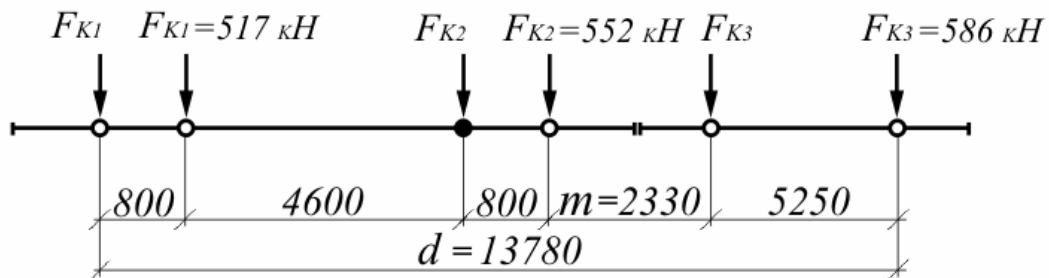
Схеми навантажень на підкранову балку:
